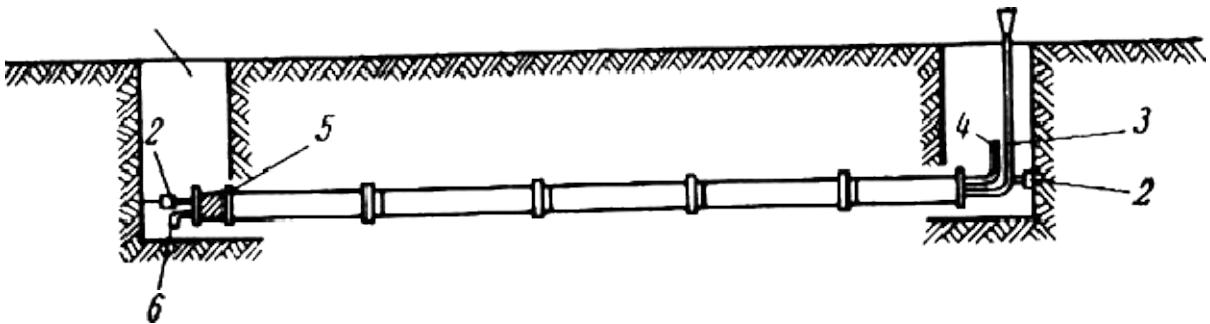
Схемы испытания трубопровода на внутреннее давление
